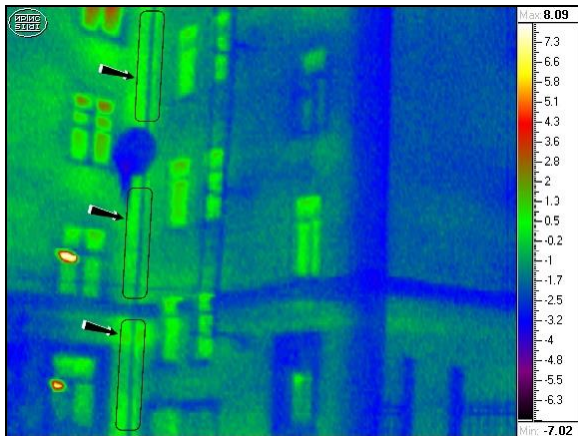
Дефект конструкции здания. Стык между фасадами С и D
